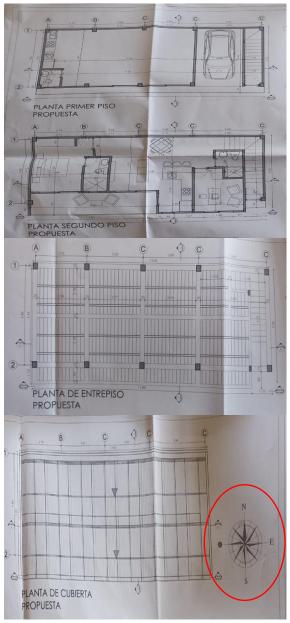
[Fotografías Andres Vargas] Plantas y Rosa de los vientos
